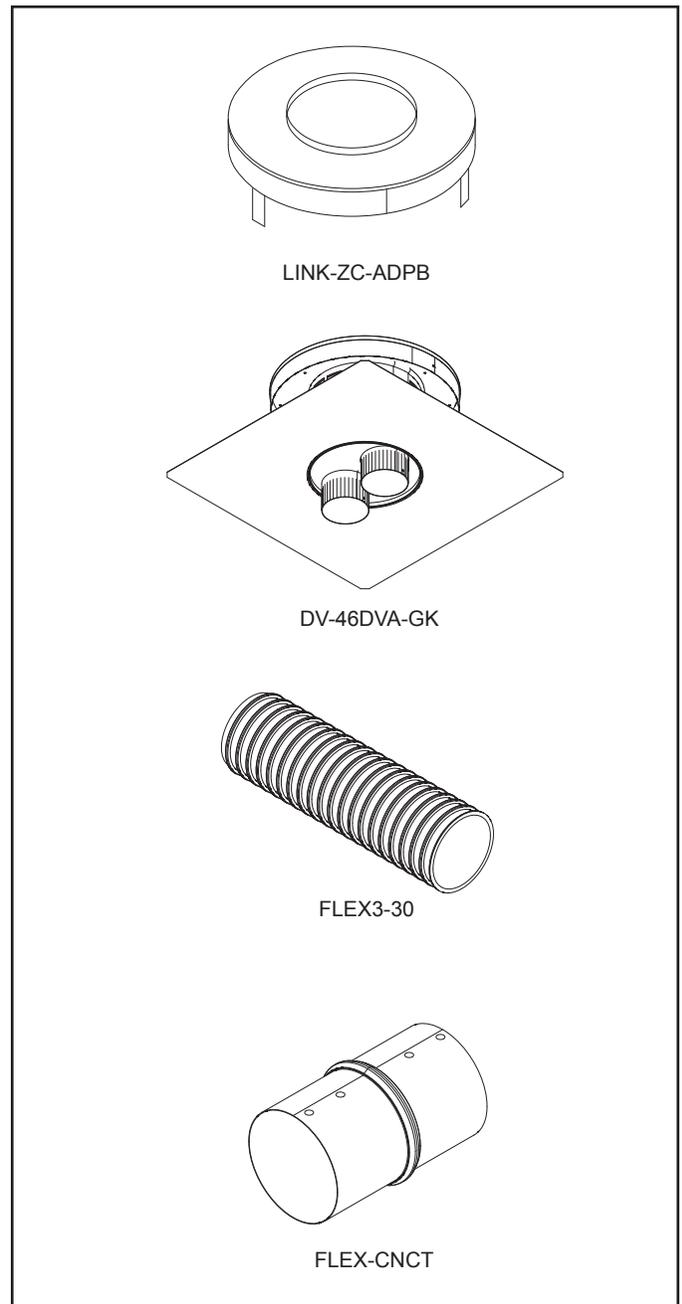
Kits d'accessoires de revêtement flexible d'évacuation directe
